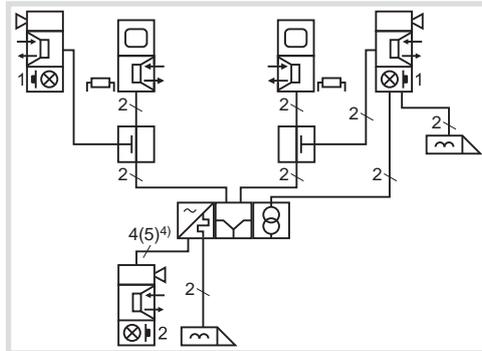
A 2 fili – Installazione stazioni da porta dell'appartamento
